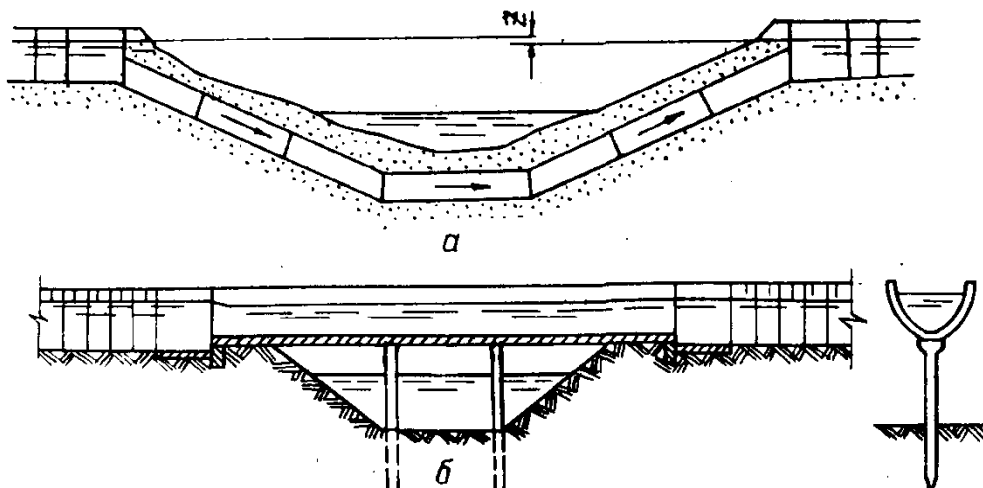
Схемы водопроводящих сооружений: а-дюкер; б-акведук
